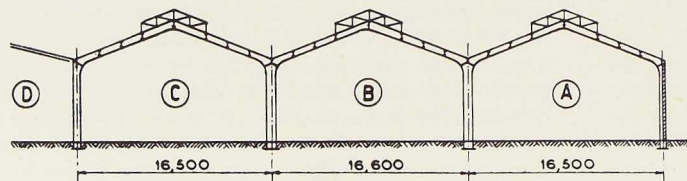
Coupe transversale des halles A, B et C d'une longueur de 220 mètres.
